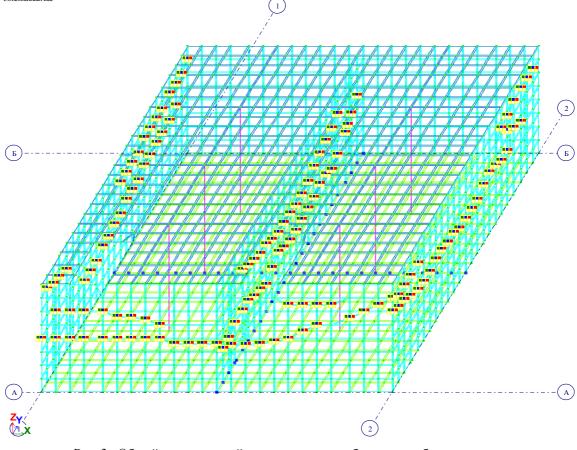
Общий вид расчетной схемы с учетом рабочих швов бетонирования
